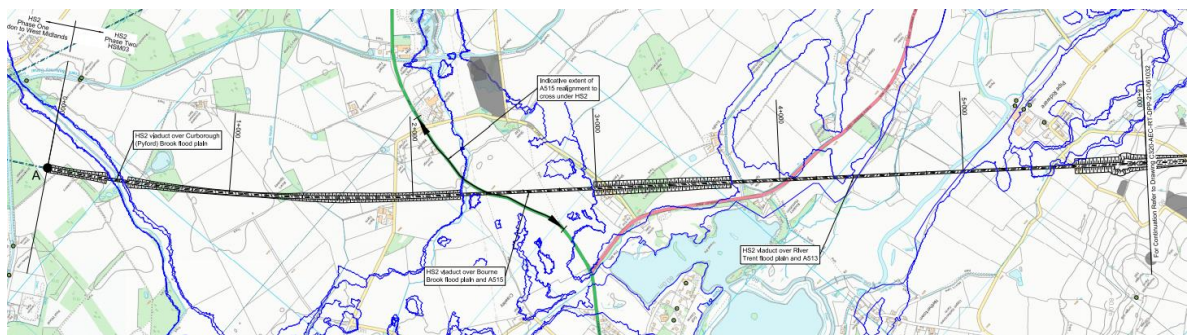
Planta do traçado viaduto sobre o Rio Trent (Unido, HSM03 Sheet1).
